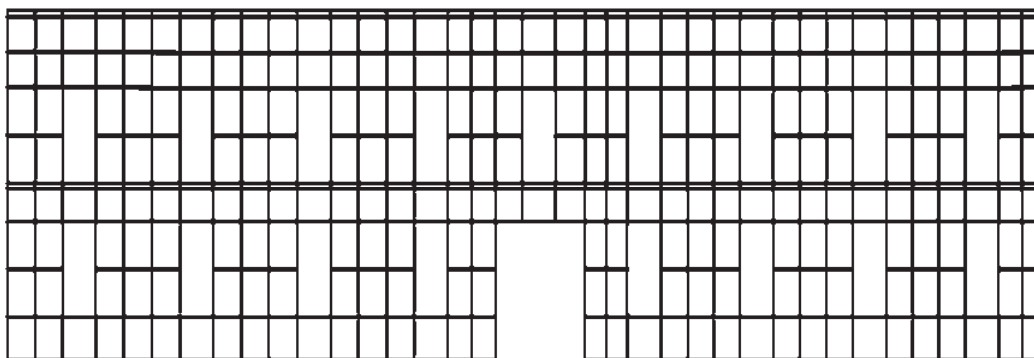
Modelo de elementos rígidos para la fachada norte.
